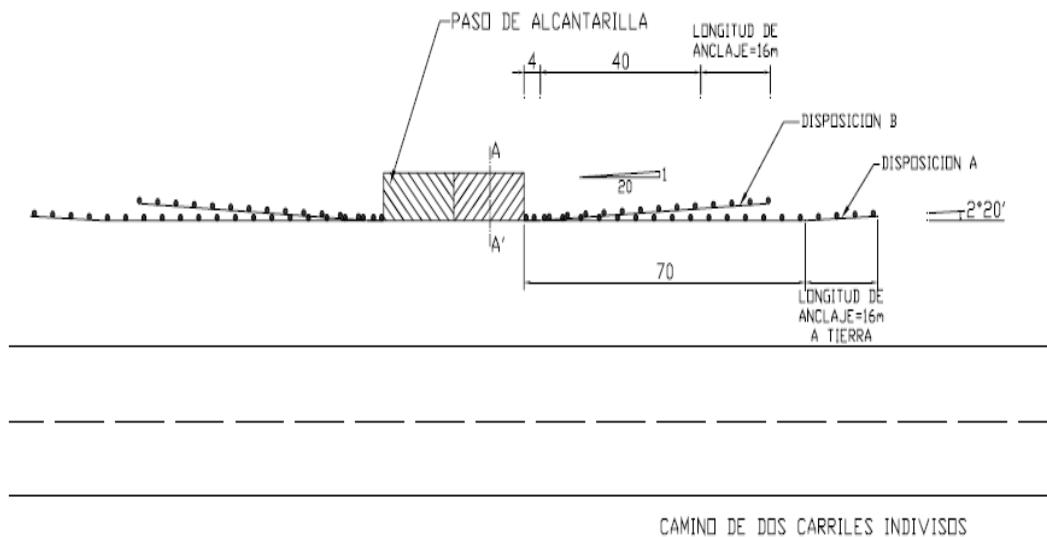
Longitud recomendable para barreras de alcantarillas. (Fuente: C7, Norma DNV).
